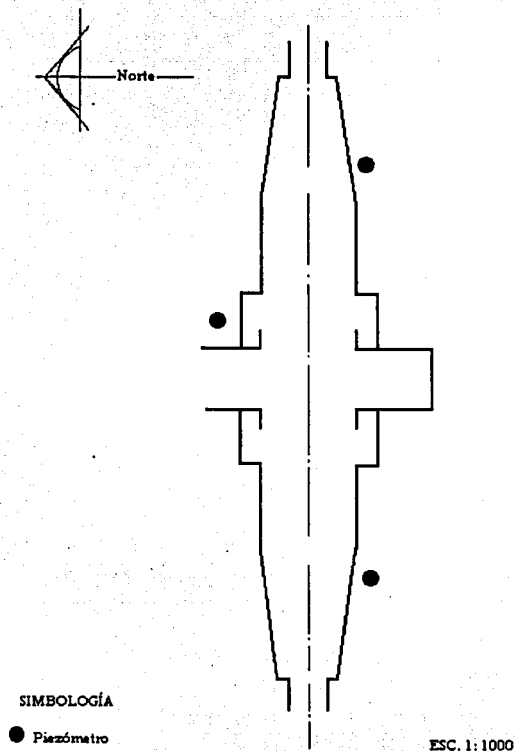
Esquema de los piezómetros instalados en la estación Colegio Militar.
